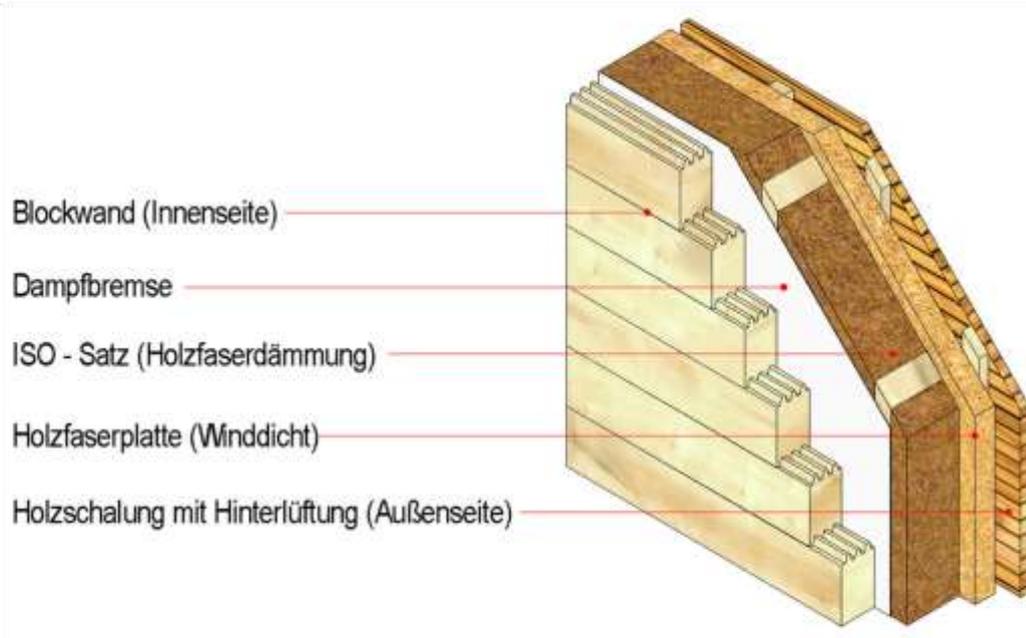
Wandaufbau Holzblockbau mit Aussendämmung
